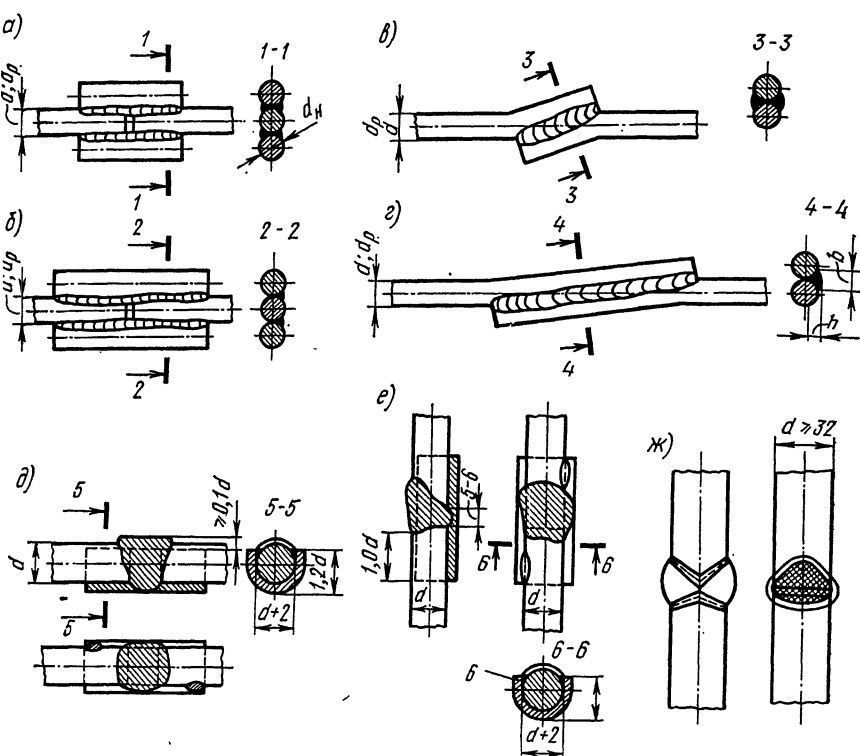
Технология стыковых соединений арматурных стержней с помощью дуговой сварки
